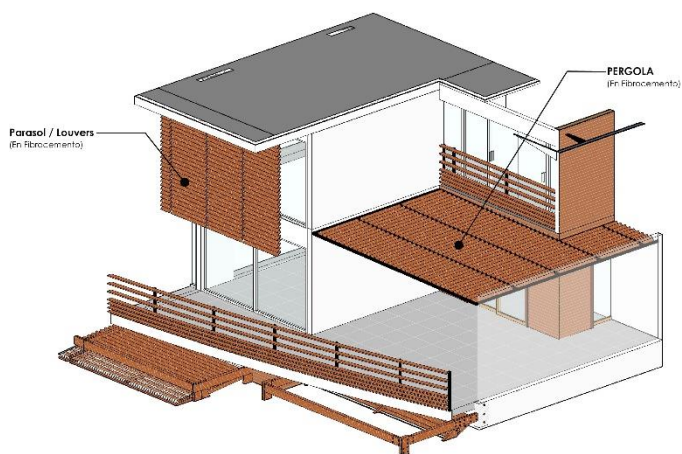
Detalle de Pérgolas y Louvers. Fuente: Elaboración propia
